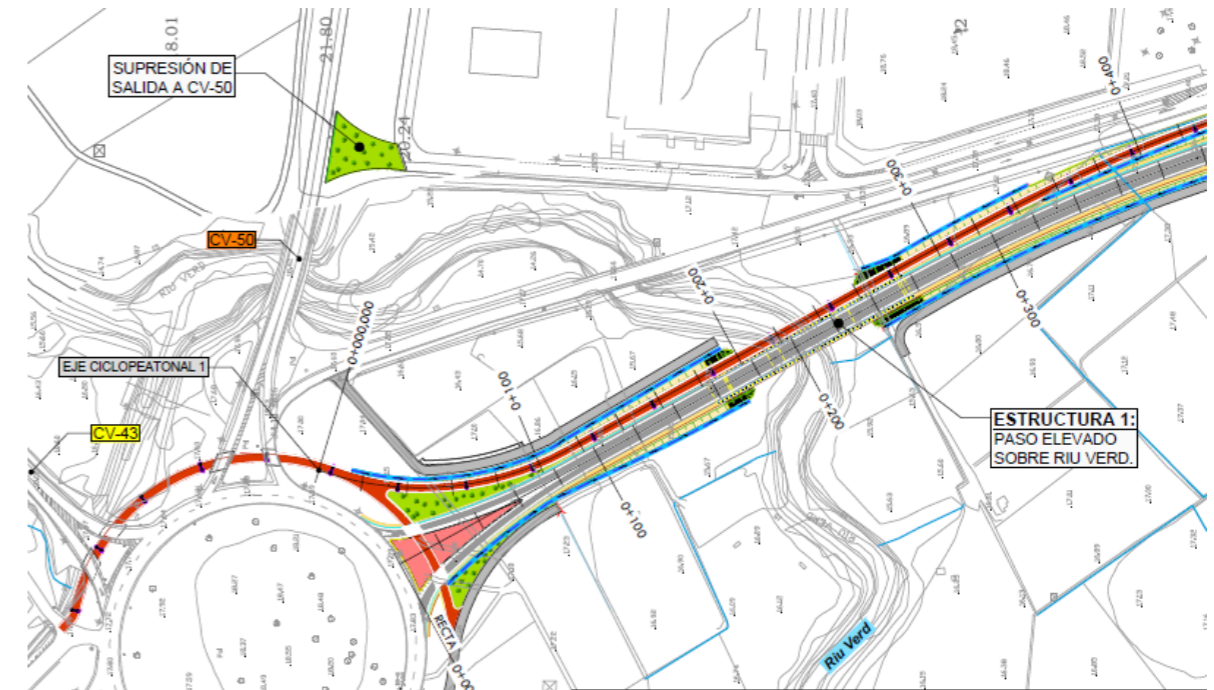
Planta de disposición del trazado en planta del cruce con Riu Verd.
